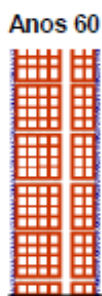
Parede de alvenaria em tijolo vazado
